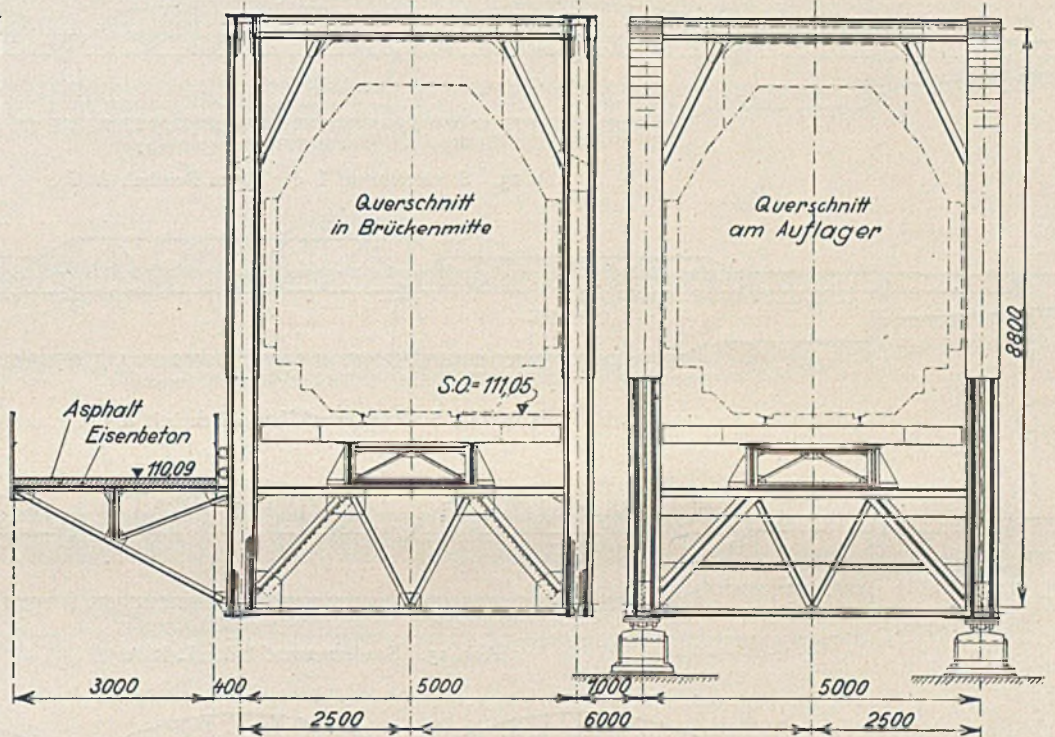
Brückenquerschnitt nach dem Vorentwurf.
